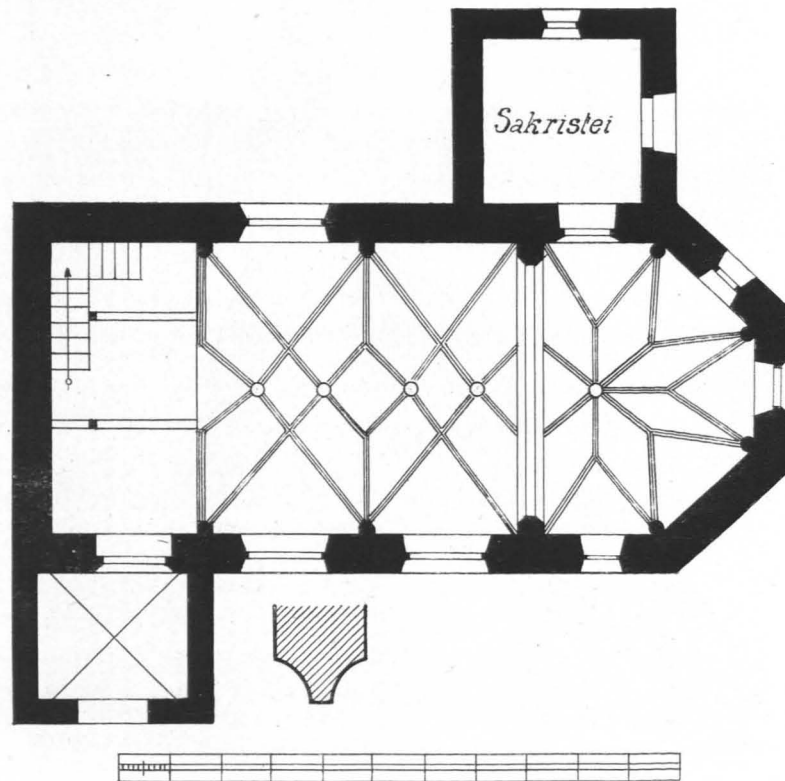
Holzhausen, Filialkirche, Grundriß 1 : 150 (S. 458)
